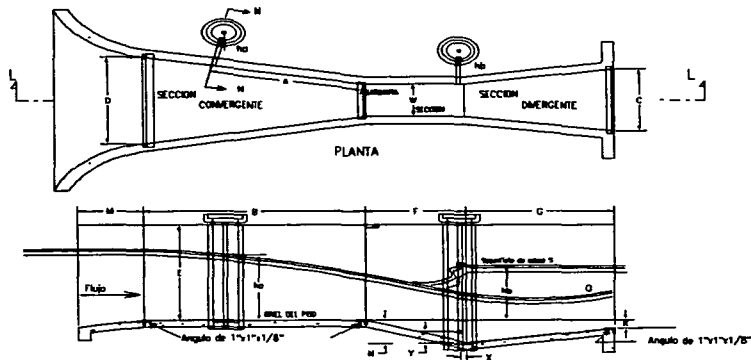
Plano de elevación de un Canal Parshall con sus partes.
